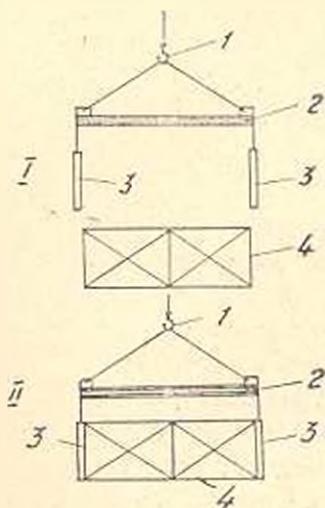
Схема подвески боковых щитов опалубки арки. 1—крюк кабельного края; 2—траверс; 3—боковые щиты опалубки; 4—жесткий каркас арки.
